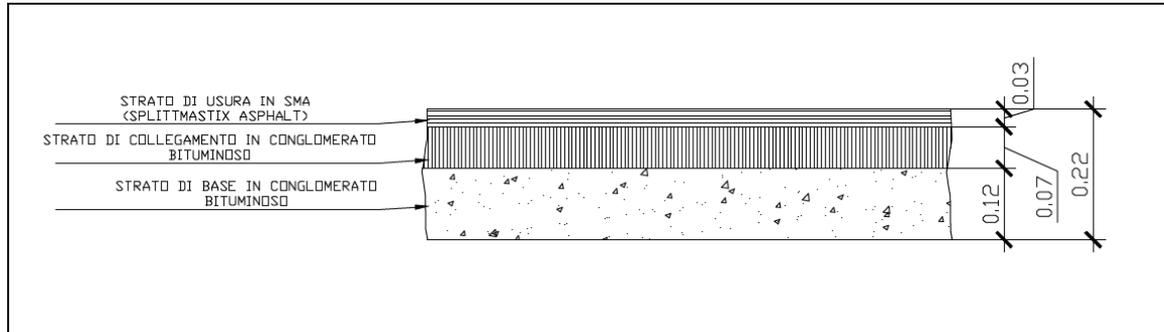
COMPOSIZIONE DELLA SOVRASTRUTTURA STRADALE
